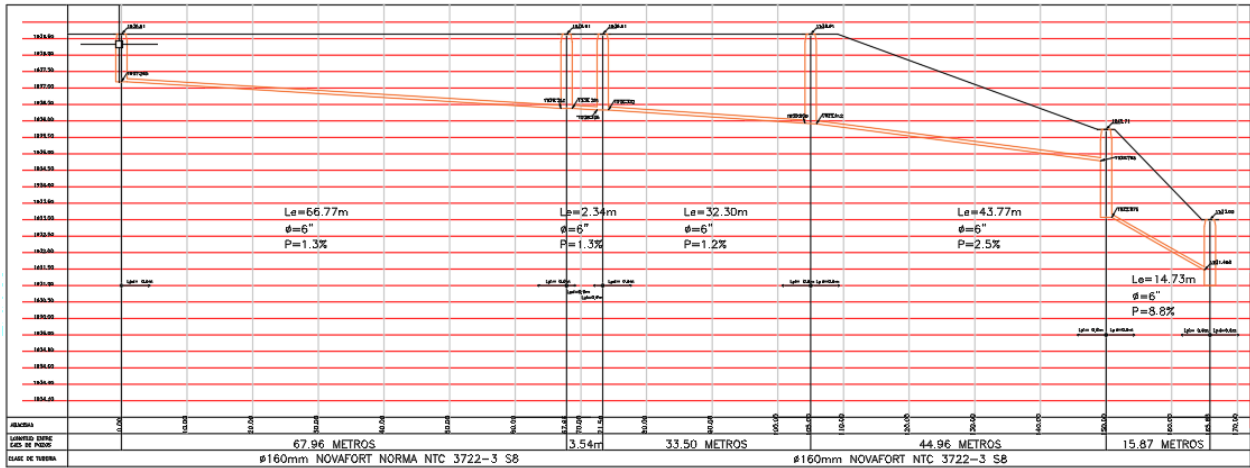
Perfiles Pozos Alcantarillado Sanitario Torcaza
